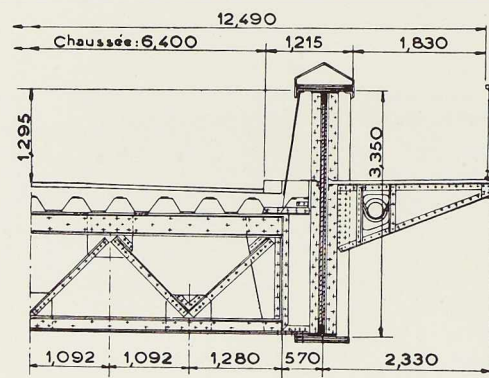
Pont de Upton-on-Severn. Détail des maîtresses-poutres au droit des piles.
